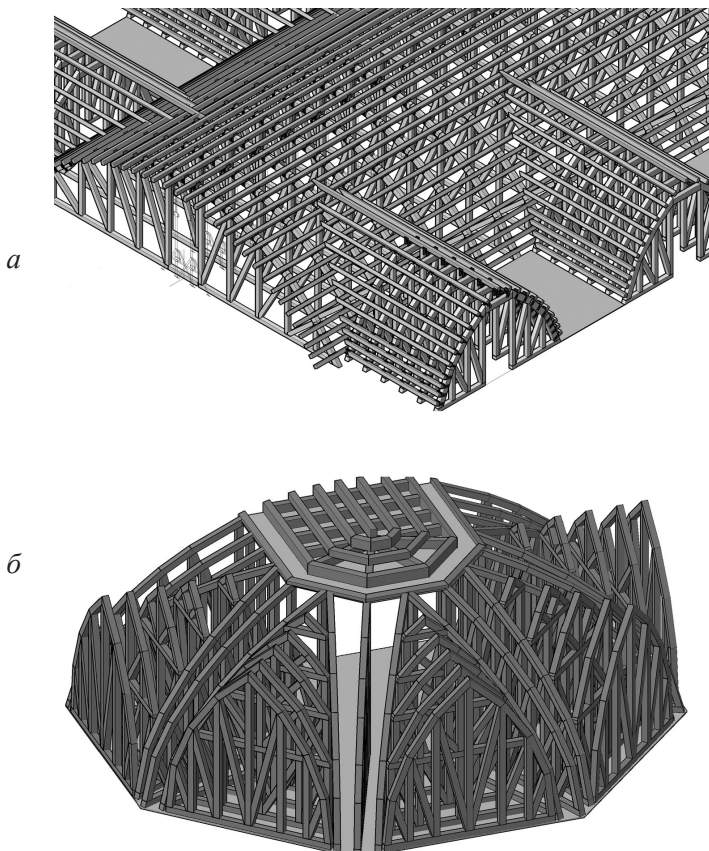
Схемы опорной системы монолитных железобетонных сводов Церкви Святого Духа:
